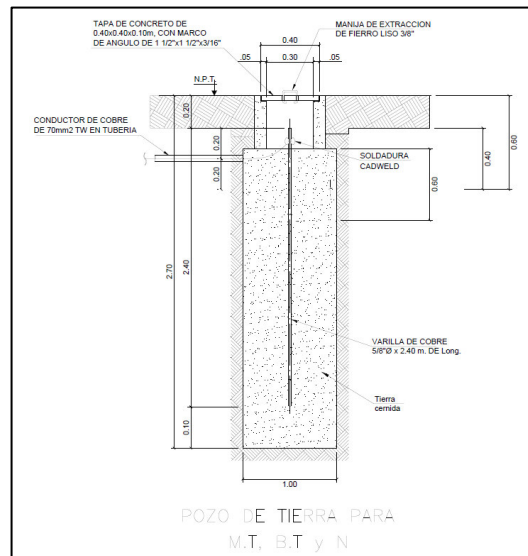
Detalle de ejecución de pozo a tierra de media tensión y neutro de media tensión. Fuente: Daca Ingeniería y Proyectos S.A.C.
